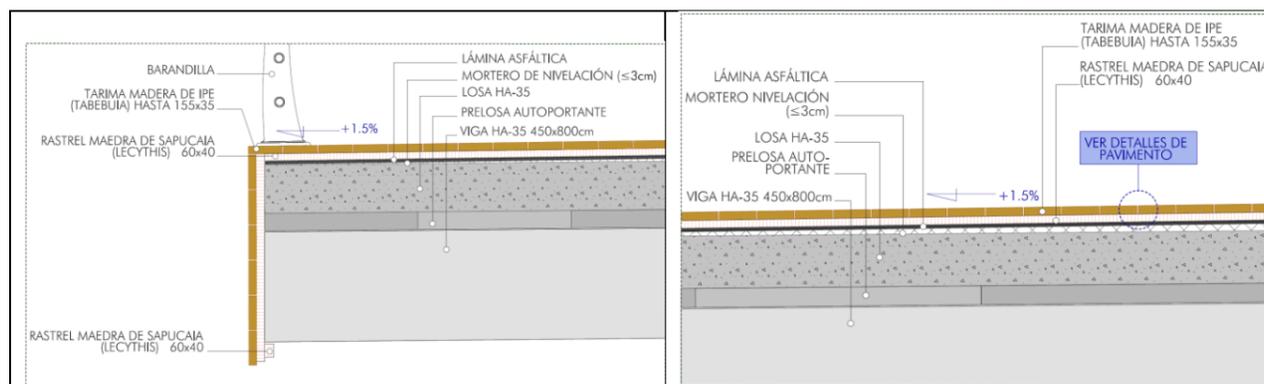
Detalle de elementos de la sección tipo (estructura completa)
